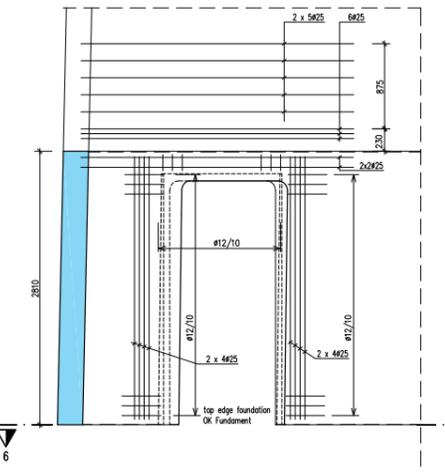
DETAIL TUEROEFFNUNG DETAIL DOOR OPENING
